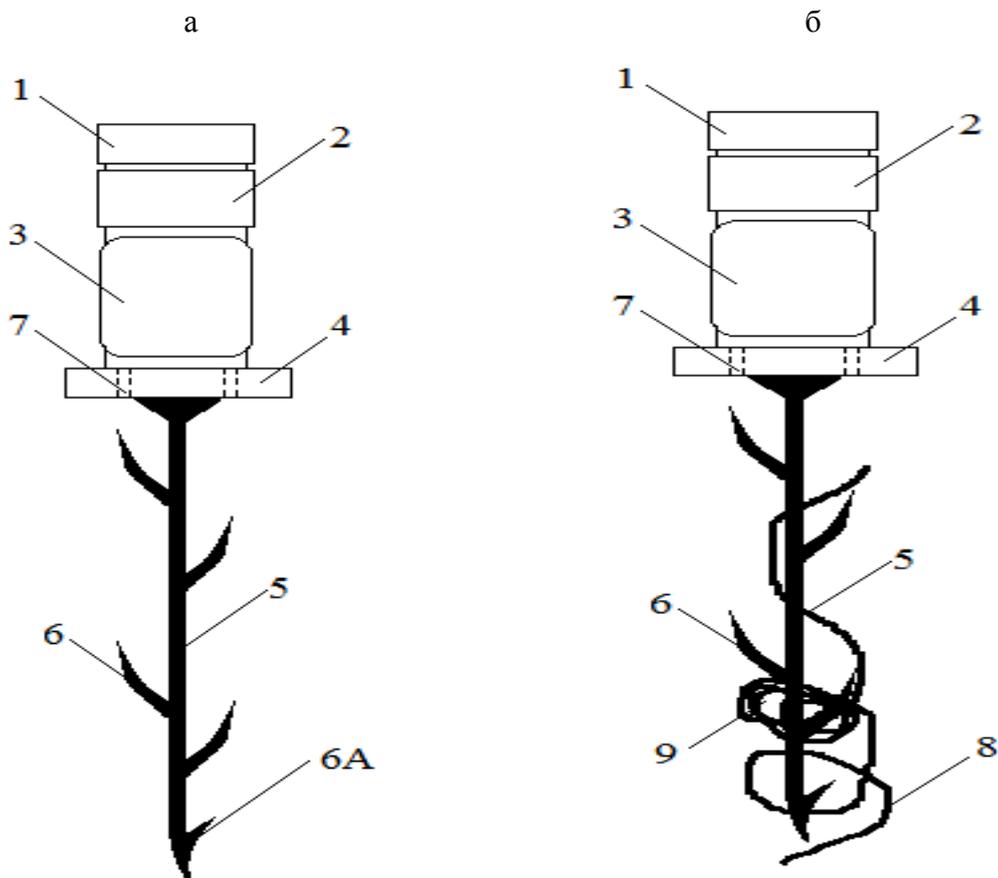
Схема извлечения оборванного кабеля из скважины с помощью безмуфтовой длинномерной трубы:
